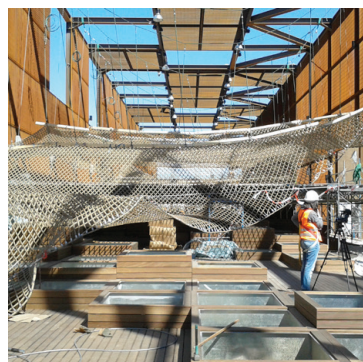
Imagens da construção do pavilhão. De outubro de 2014 à abril de 2015
